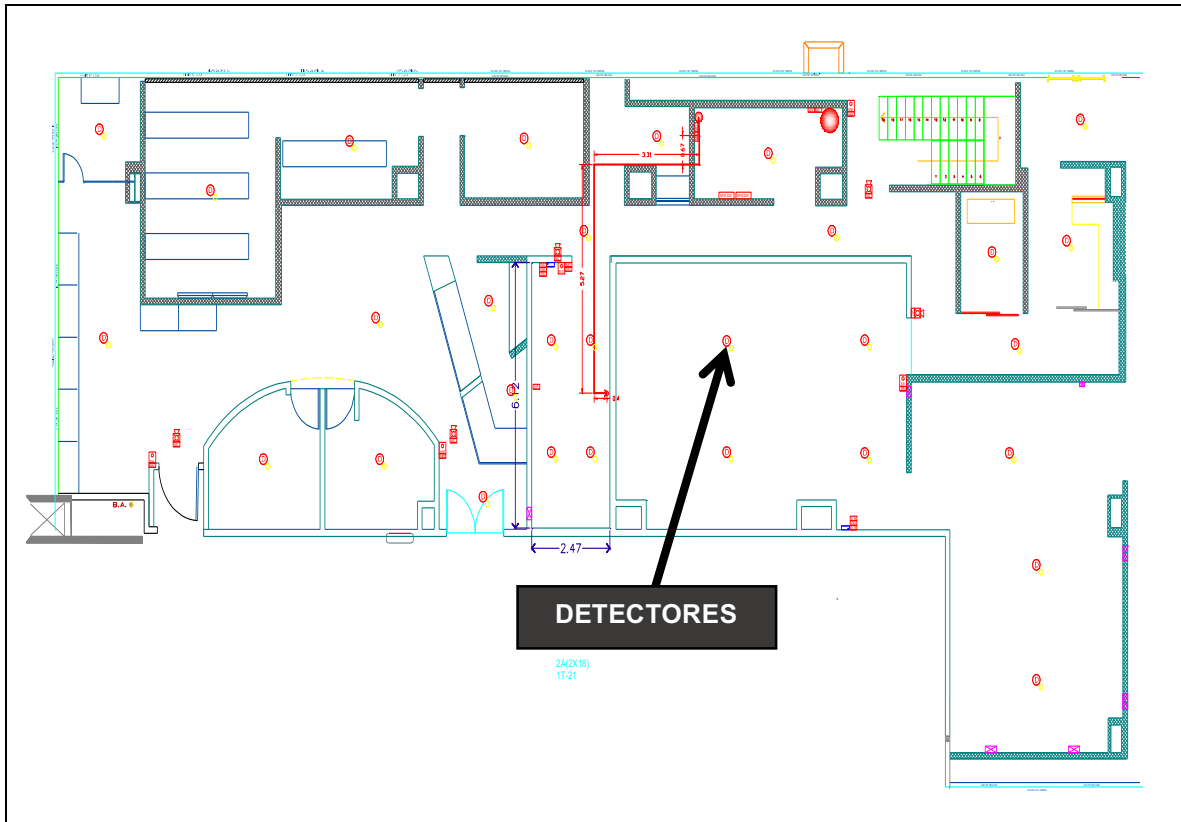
Planta baja, muestra de ubicación de detector de humo primer nivel
